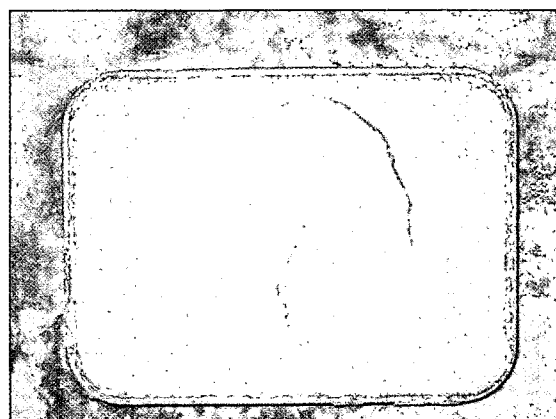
養生方法2のひび割れ(高強度モルタル)
